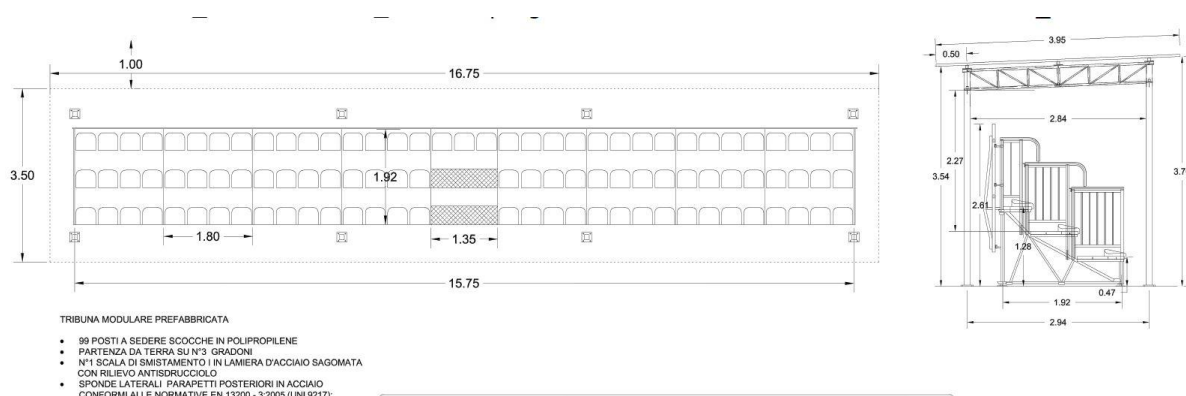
Tribuna coperta. Estratto Tav.A.03.b.1\_ Stato di progetto
